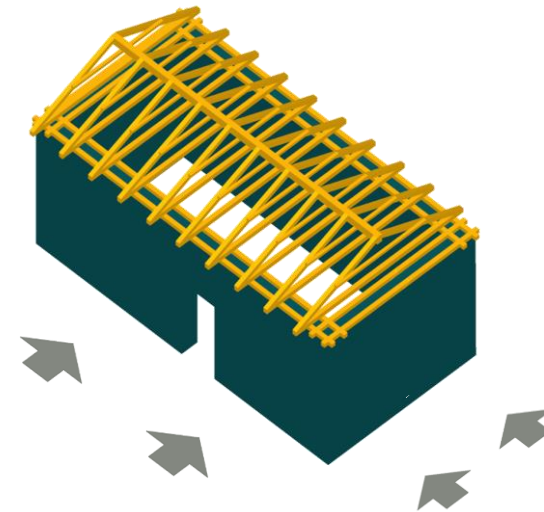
Estructura de cubierta de una vivienda tradicional mejorando el comportamiento estructural. Fuente: Elaboración propia.
